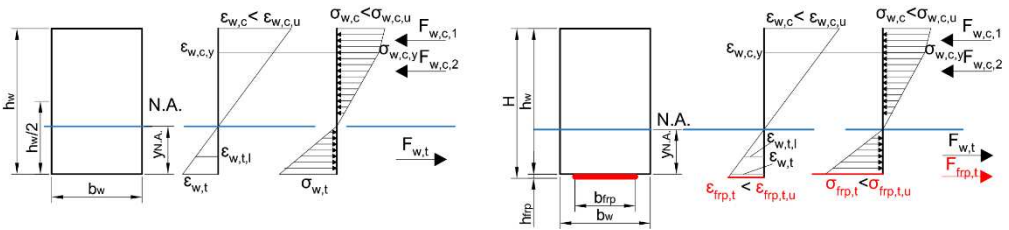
Nomenclatura y diagramas de la relación entre la tensión y la deformación para el modelo en rango elástico de Argüelles [70]. Izq.: Sección de una viga no reforzada. Der.: Sección de una viga reforzada con refuerzo longitudinal. Color rojo: Refuerzo de FRP.
